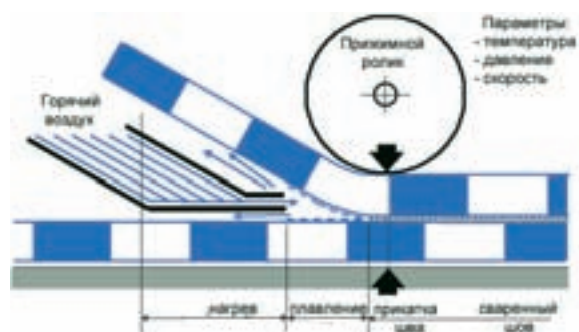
Процесс автоматической сварки.
